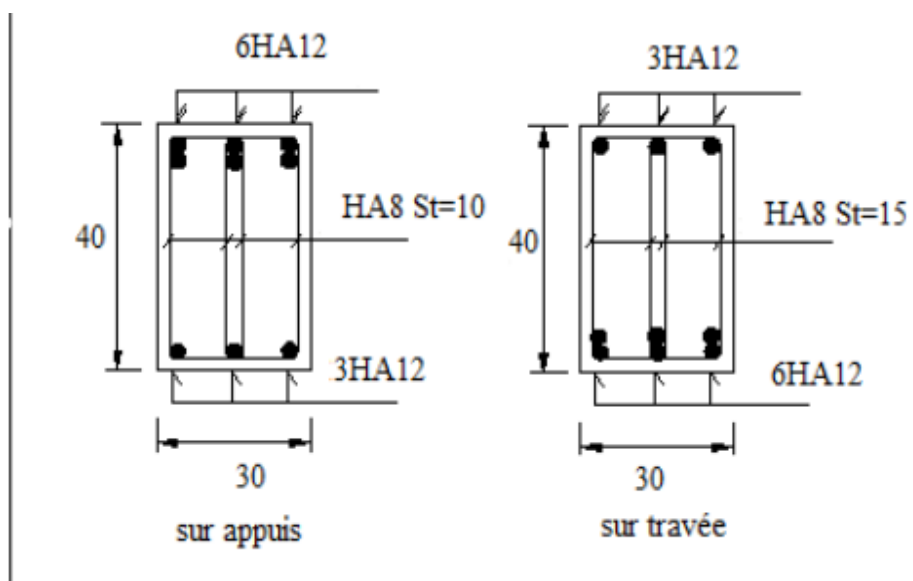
Schéma de ferrailage de poutre principale et poutres secondaires
